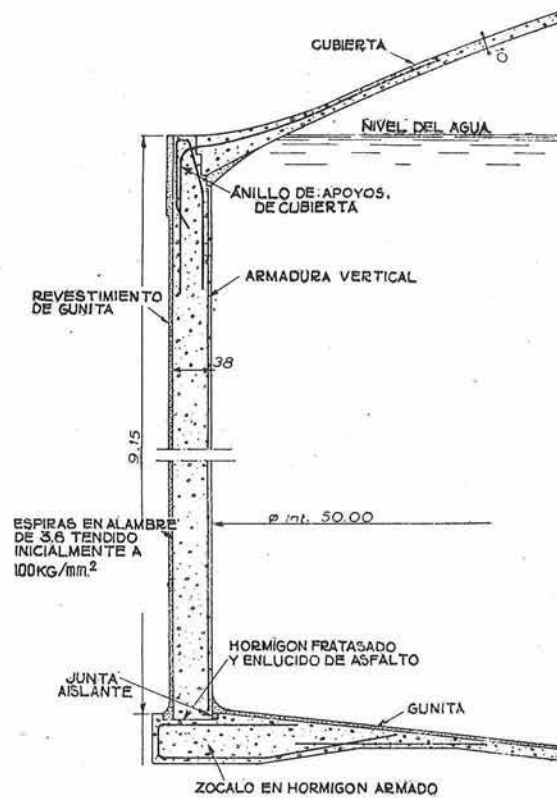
Sección vertical parcial que muestra la disposición de las armaduras.
